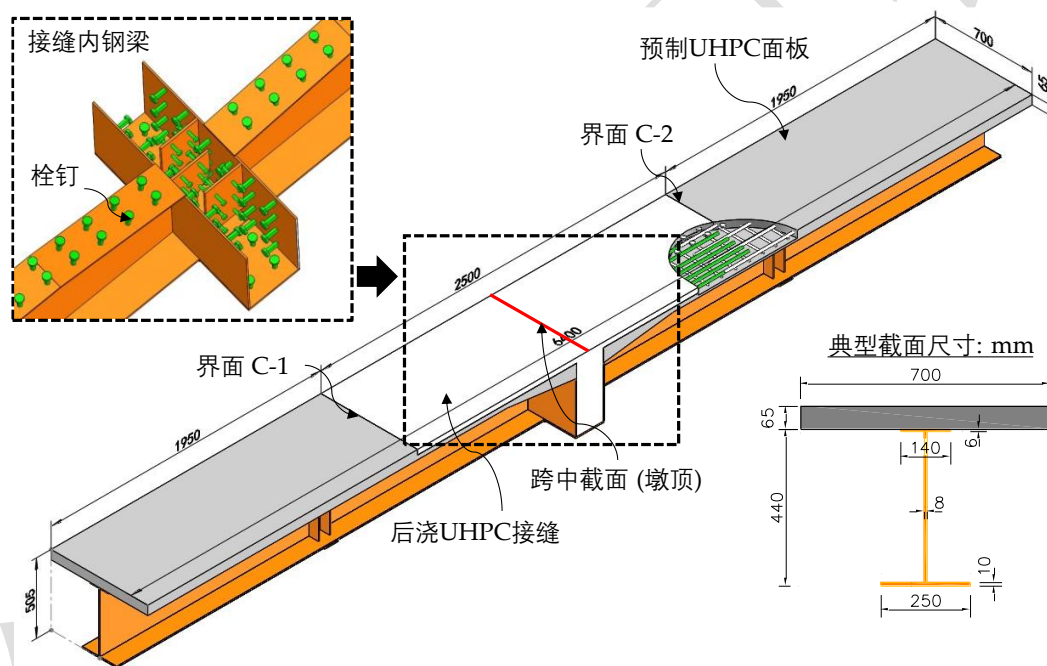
钢-超高性能混凝土组合梁横向湿接缝方案
